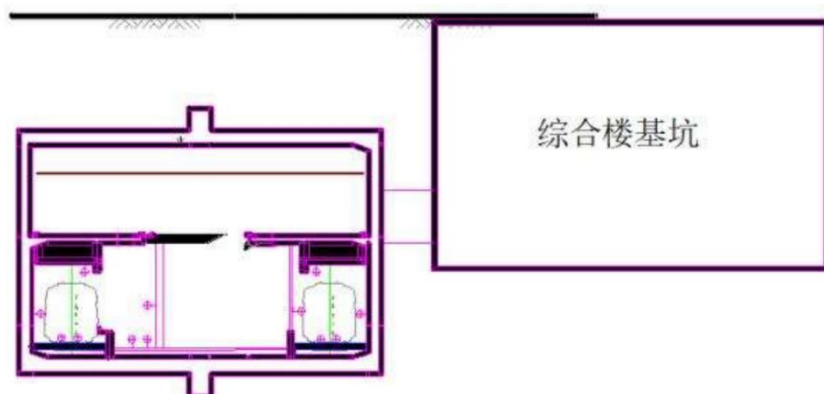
基坑与既有地铁结构横剖面位置关系示意图
